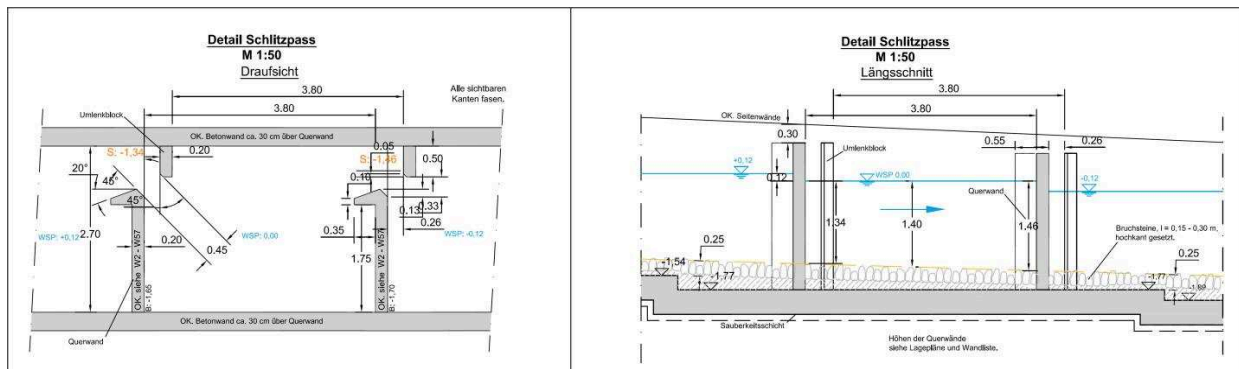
FWA Lehmen – Detail Schlitzpass (Auszug aus Planung IB Gebler)
